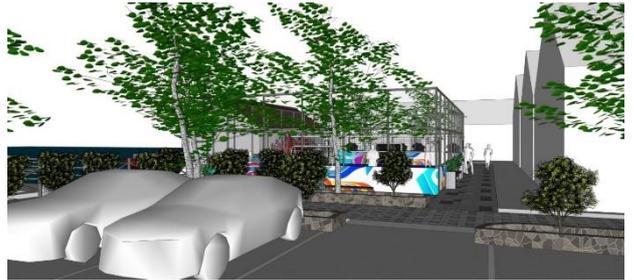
Eksisting *layout* ruang terbuka 3 Ulu
